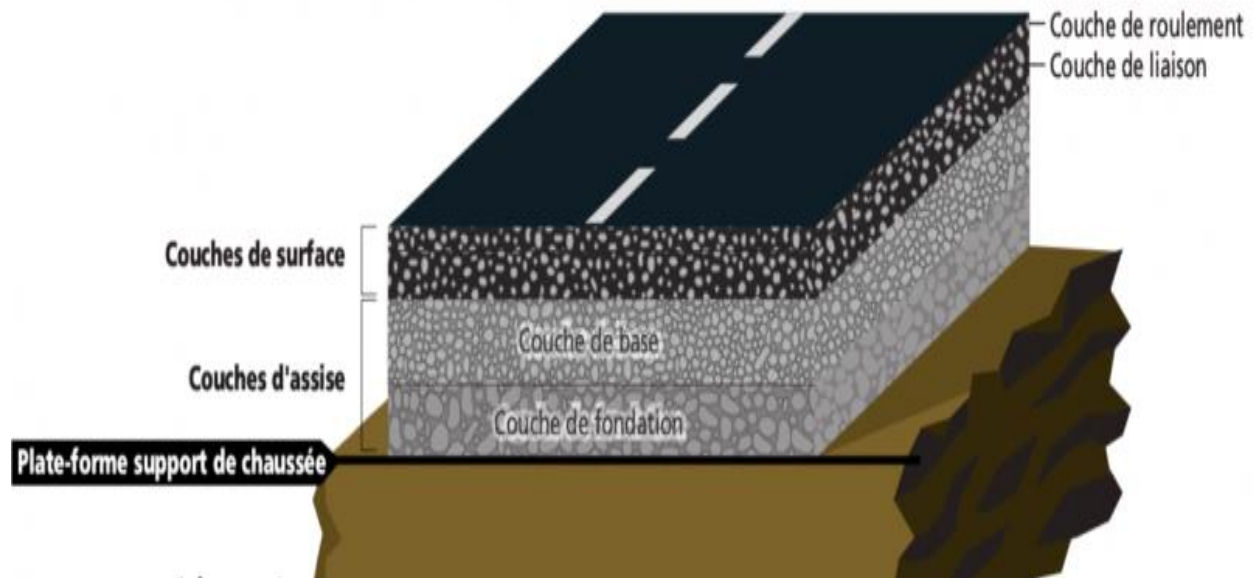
Structure type d'une chaussée souple. [17]
